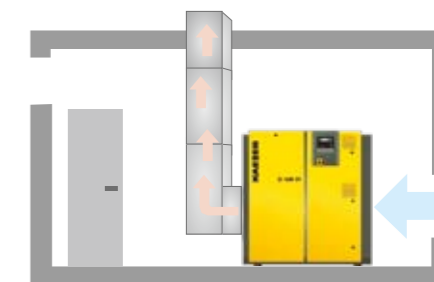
Искусственная вентиляция с использованием вытяжного канала – для установок от 11 кВт
